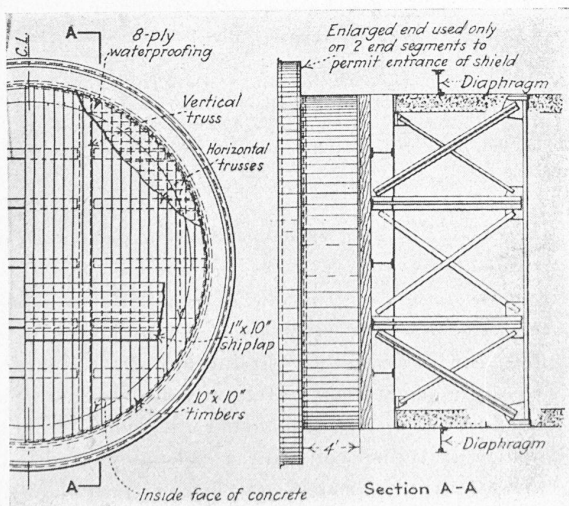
Tunnel à Détroit. — Fermeture provisoire d'un tube par batardeau, avant l'immersion.
